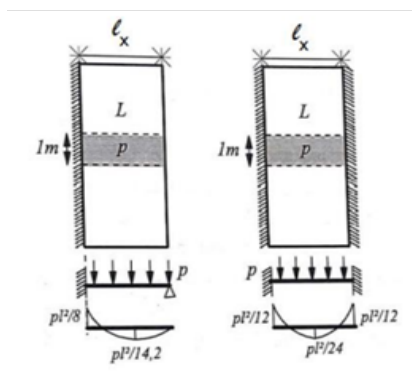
Base de Cálculo para Momentos Fletores em lajes armadas em uma direção
